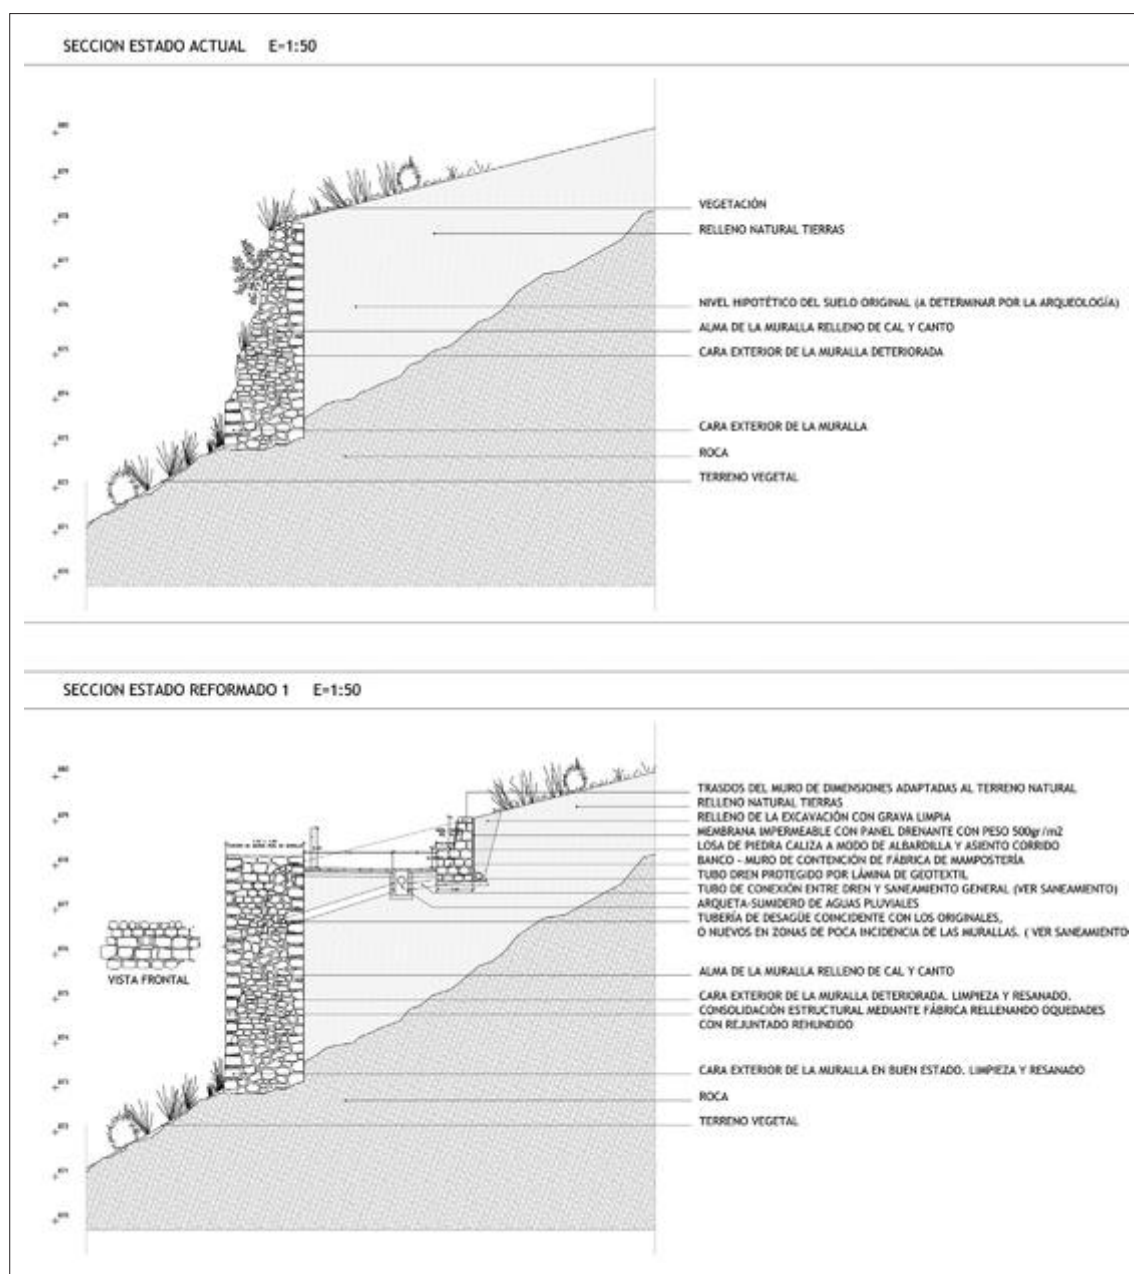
Sección tipo del camino construido junto a la muralla de Archidona
